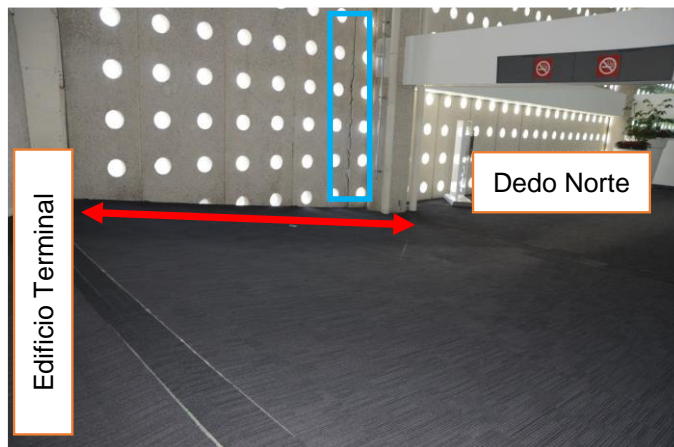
13 Desnivel y grieta en la conexión Edificio Terminal-Dedo Norte en el nivel mezanine.
